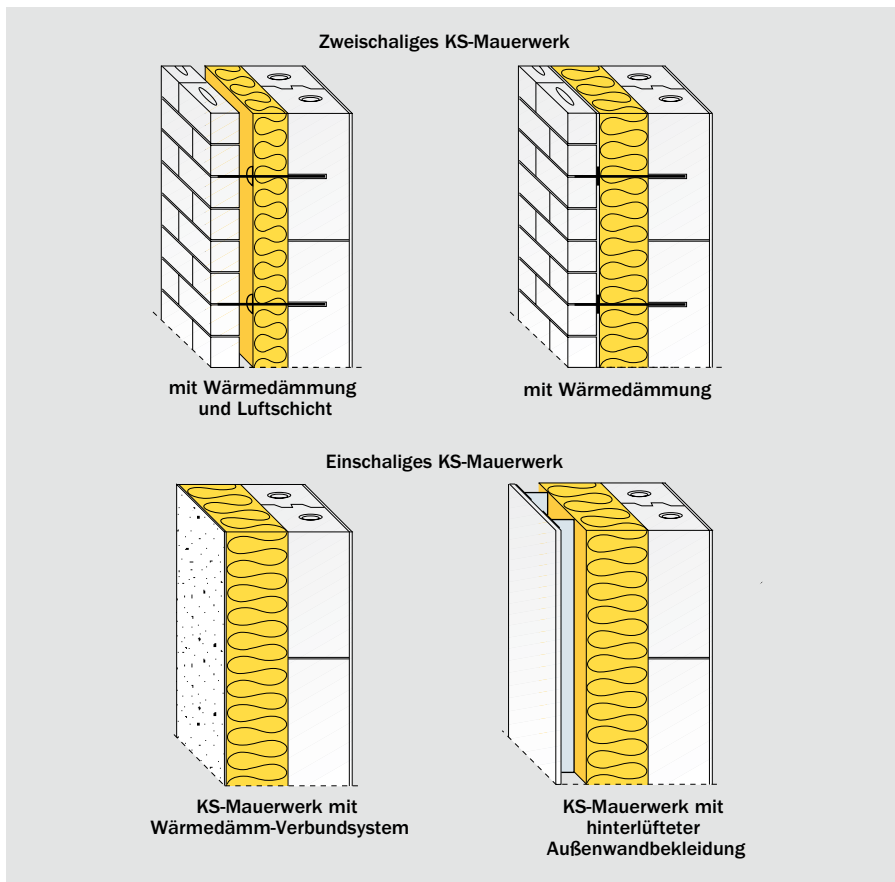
KS-Außenwandkonstruktionen für beheizte Gebäude [9]
